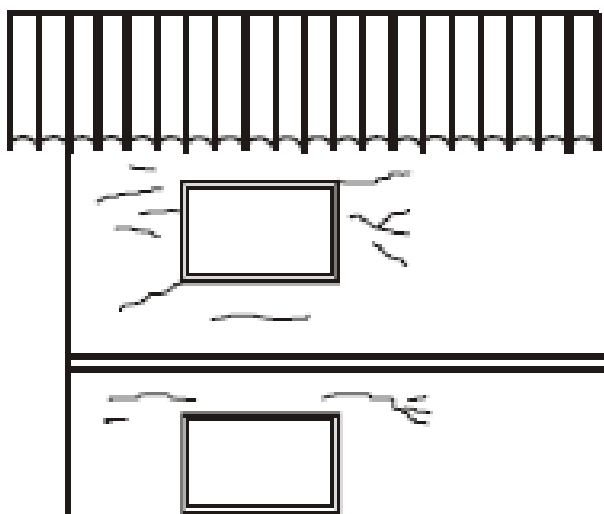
Fissuras provocadas pela expansão da argamassa de assentamento
